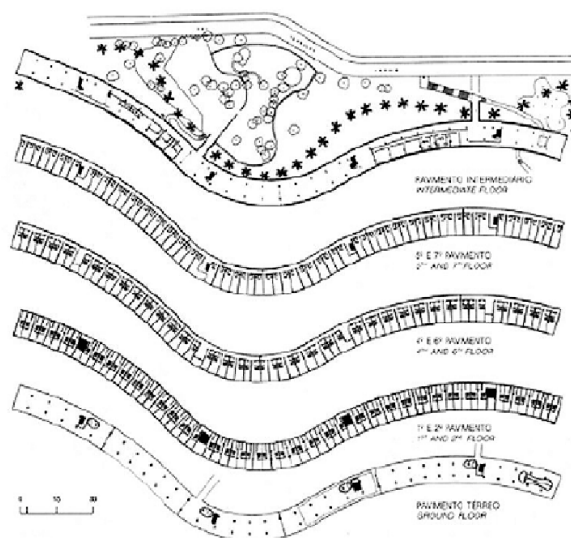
Planimetría del conjunto habitacional Pedregulho.
